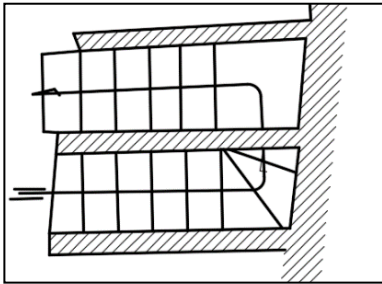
plan d'escalier. Source : plan modifié par l'auteur
